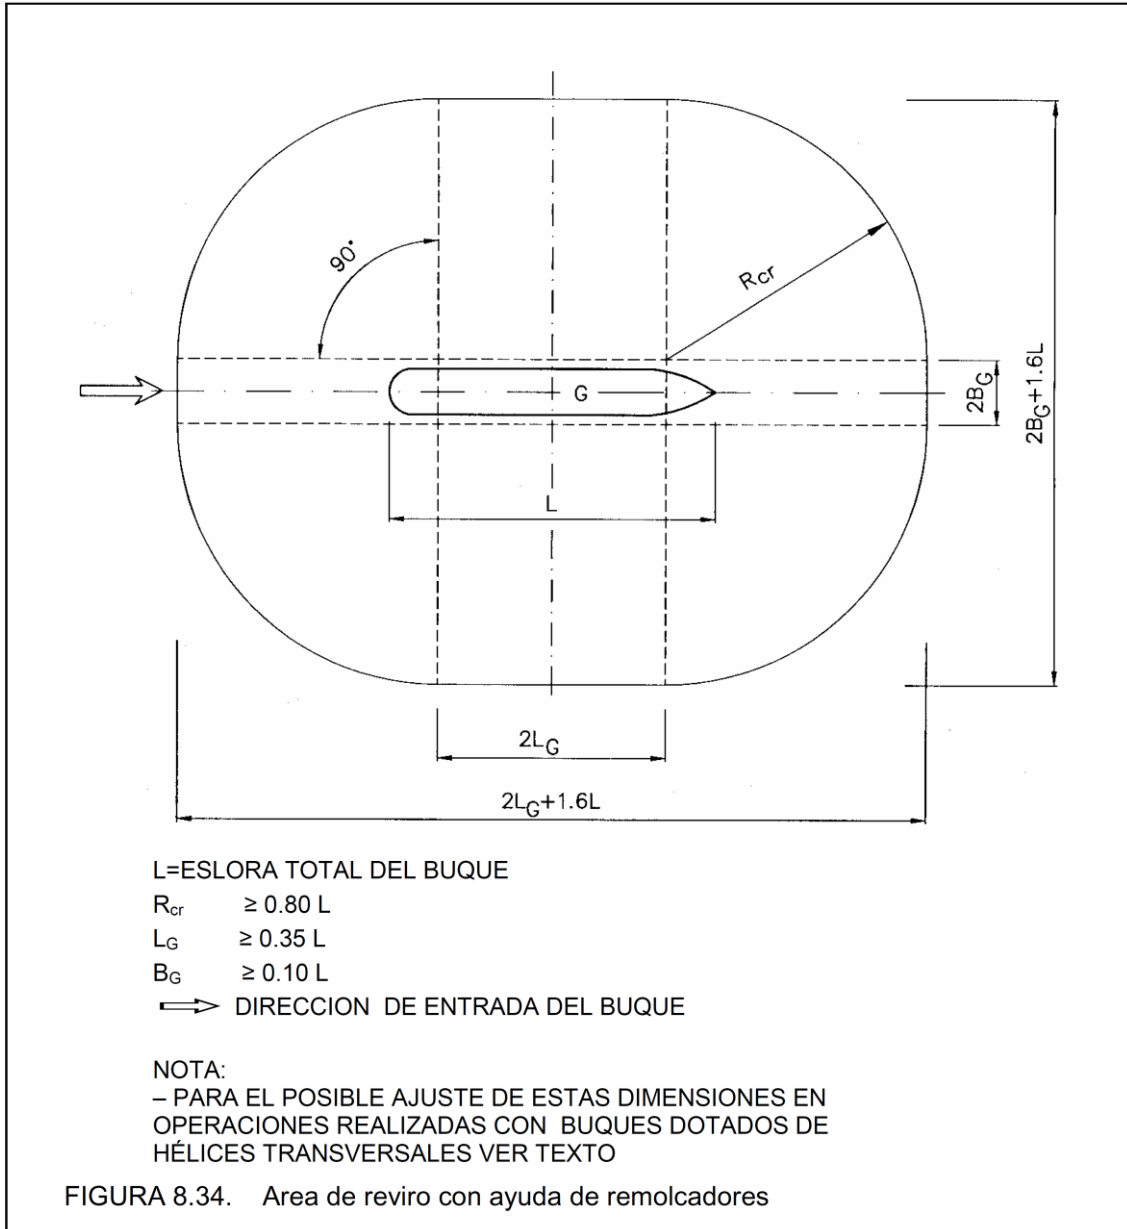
Dimensionado de la zona de giro. Fuente: ROM 3.1-99.
